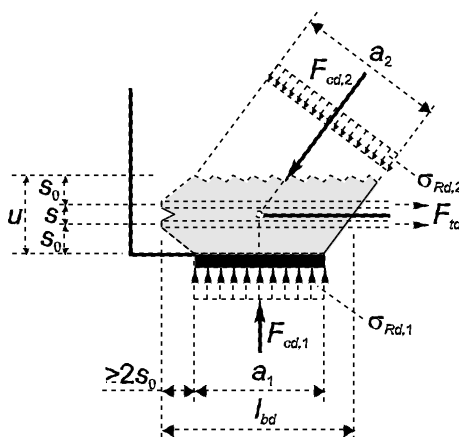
Сжато-растянутый узел с арматурой в одном направлении
